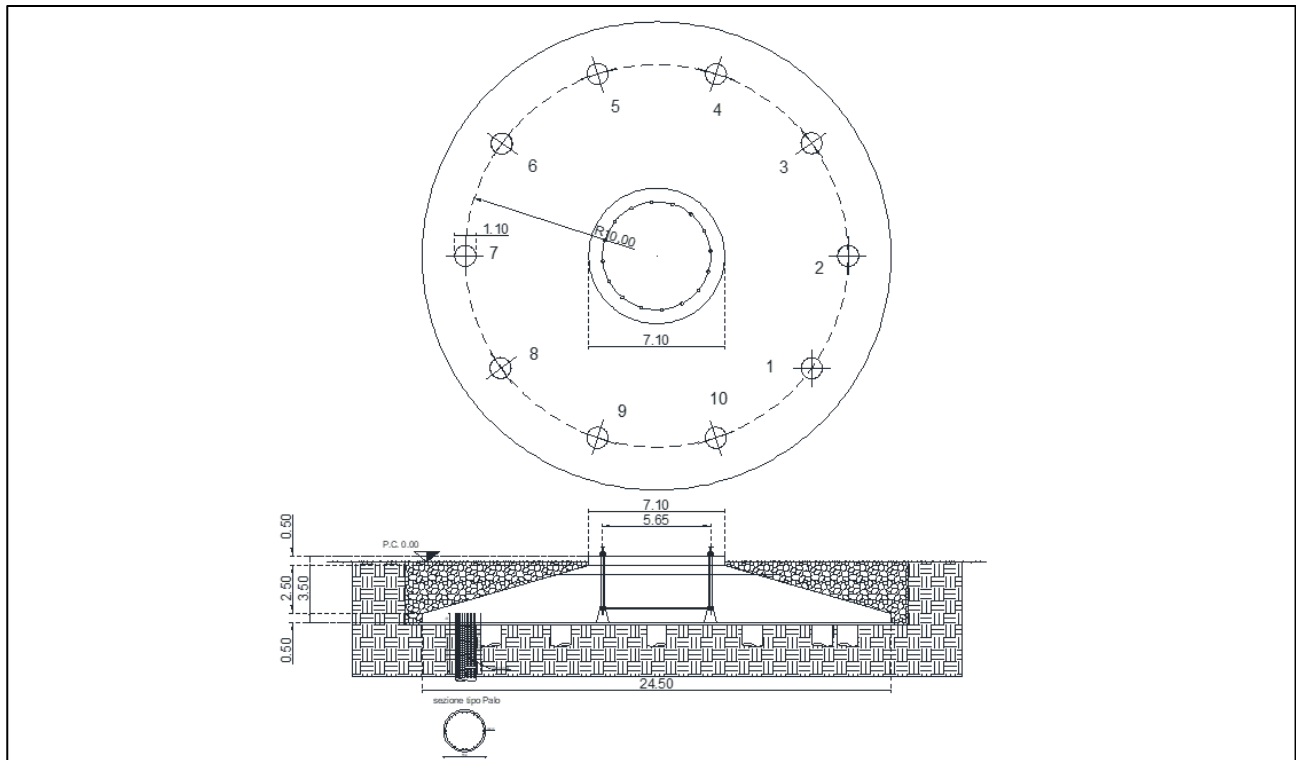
Dettaglio pianta e sezione fondazione
